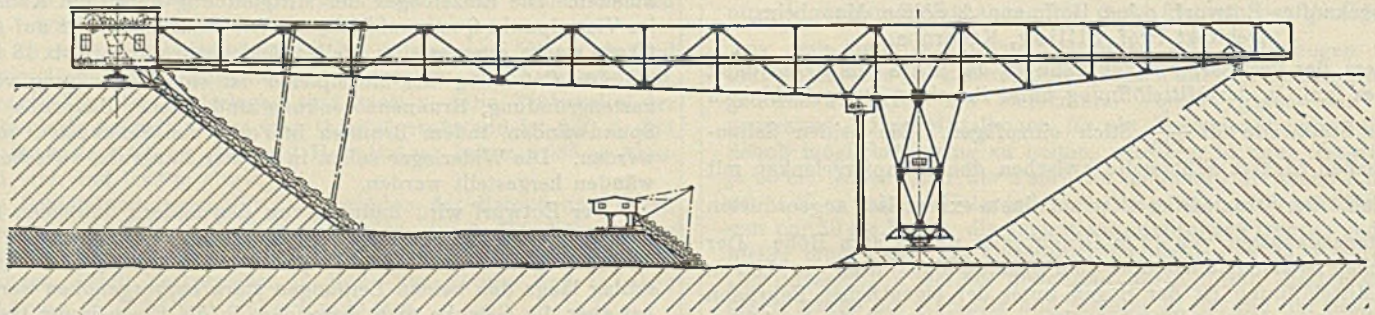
Abraumförderbrücke mit eingehängter Baggereinrichtung.
